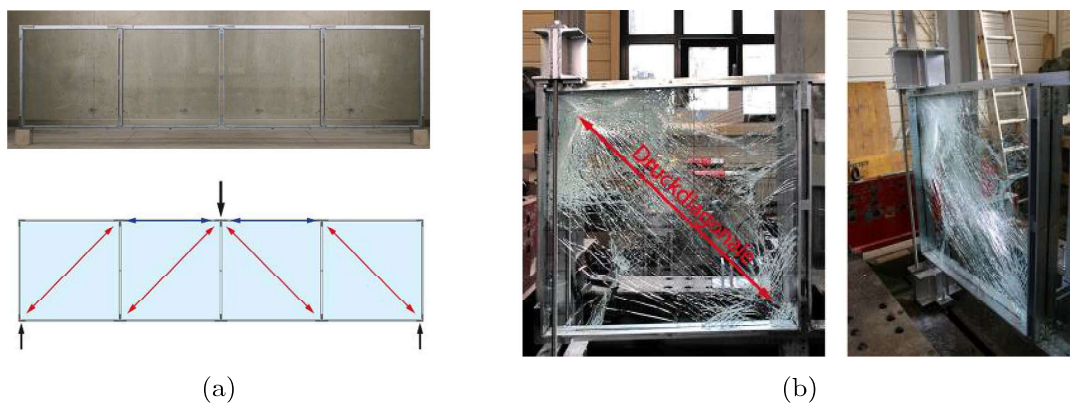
Pannelli in vetro in sostituzione a diagonali in acciaio: (a) struttura reticolare piana e schema statico; (b) rottura lungo la diagonale compressa del singolo campo [47].
